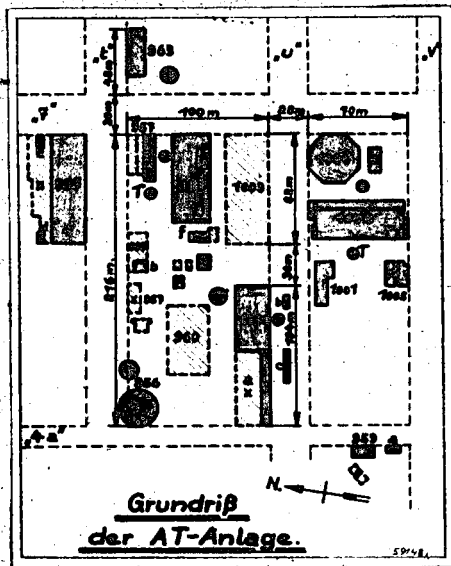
Grundriss der AT-Anlage Leuna.
